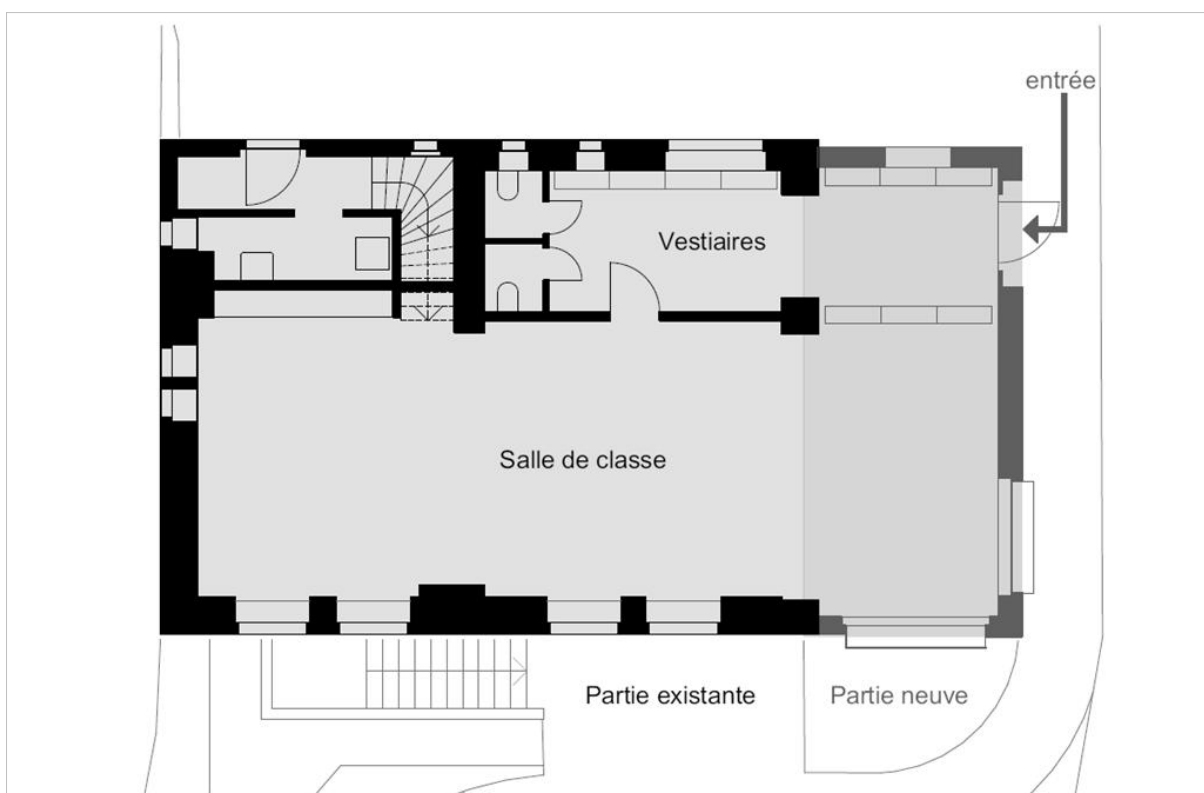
Plan du rez-de-chaussée avec agrandissement
